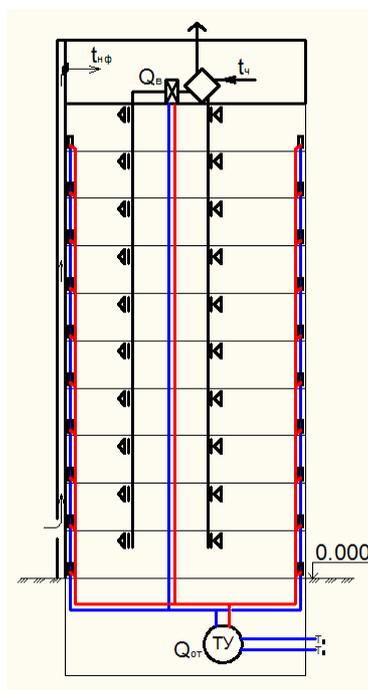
Расчетная схема отопительно-вентиляционной системы здания
